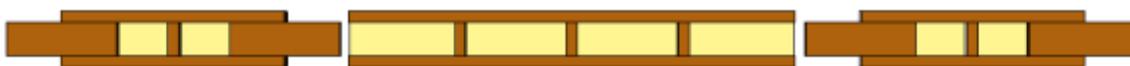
Estructura interna de vigas 122 y 244 cm y uniones con espiga. Fuente: elaboración propia.
